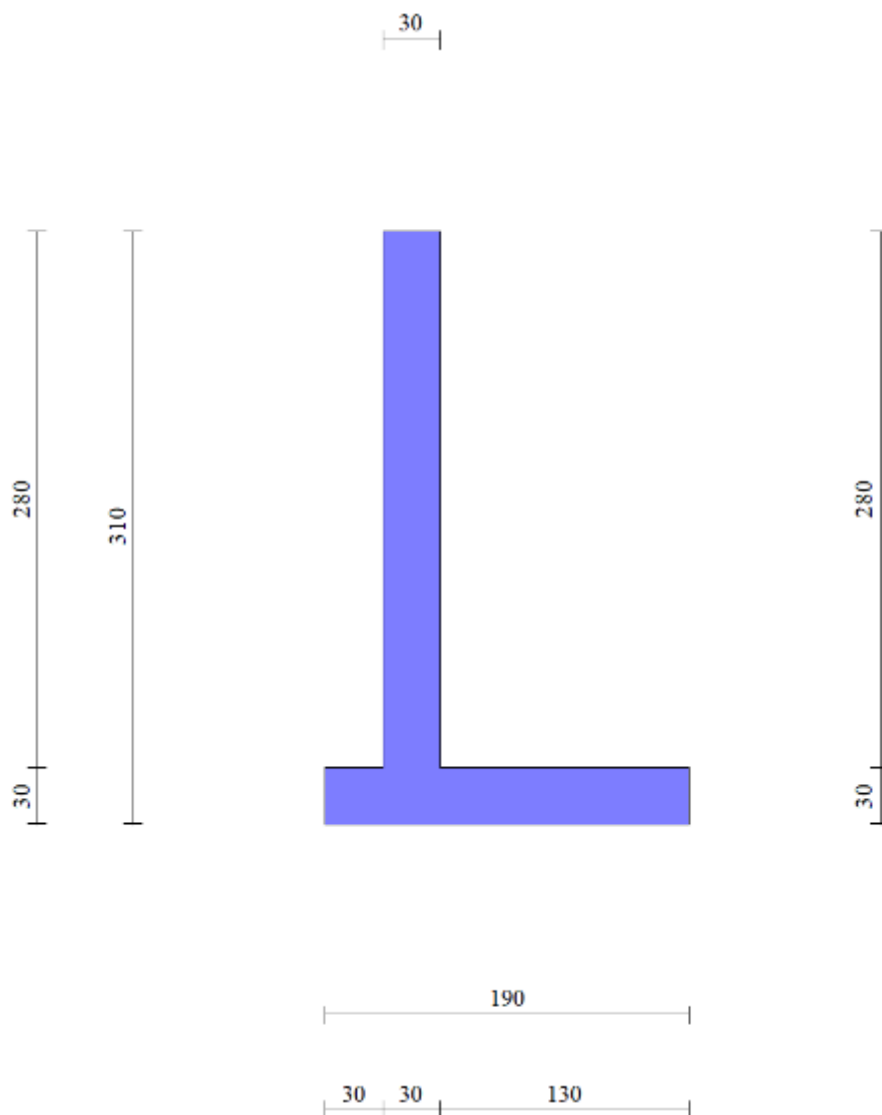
Estratto dal software di calcolo MAX 16.0 – Geometria di modellazione in sezione – intervento 11.
